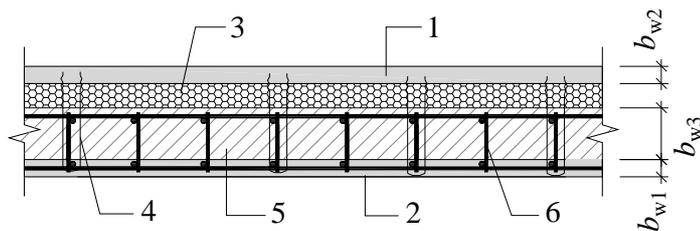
钢筋笼夹心保温叠合墙构造示意
